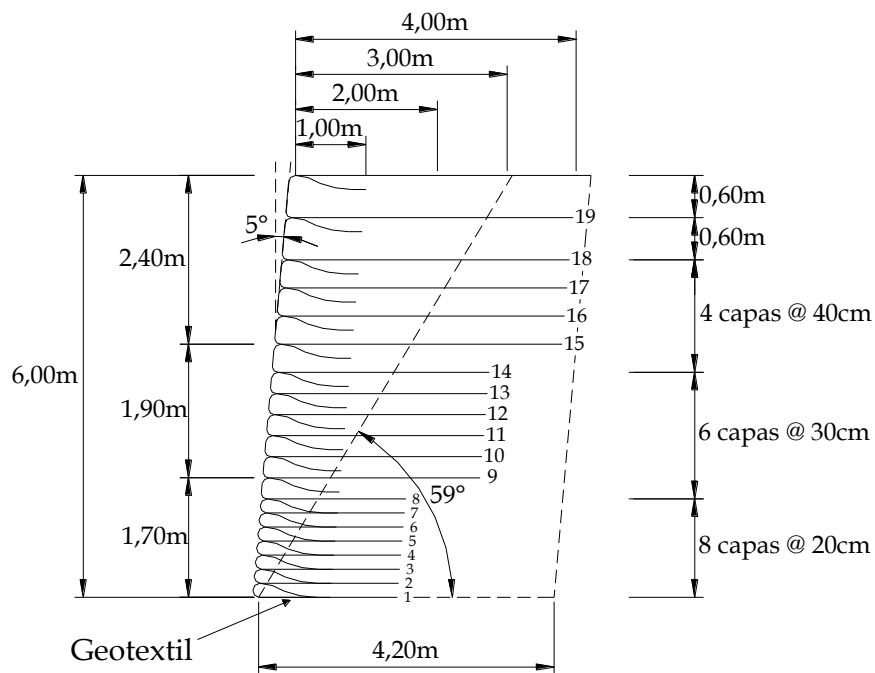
Dimensiones de muro reforzado con geotextiles.
